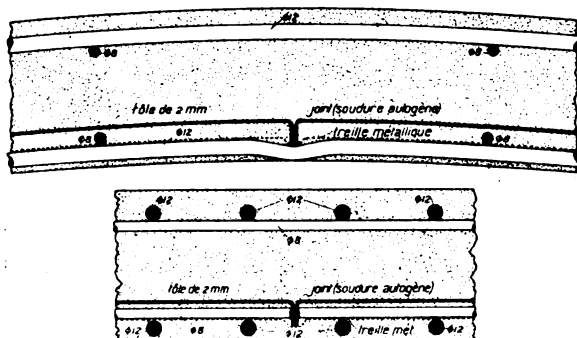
et 6. Coupe en travers et Coupe en long, échelle 1:6, d'un joint de deux panneaux de la partie tôle.
